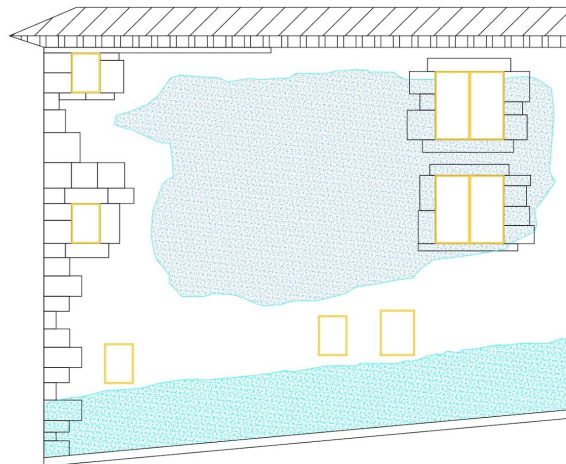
Croquis de la fachada lateral. (Fuente: Propia)
